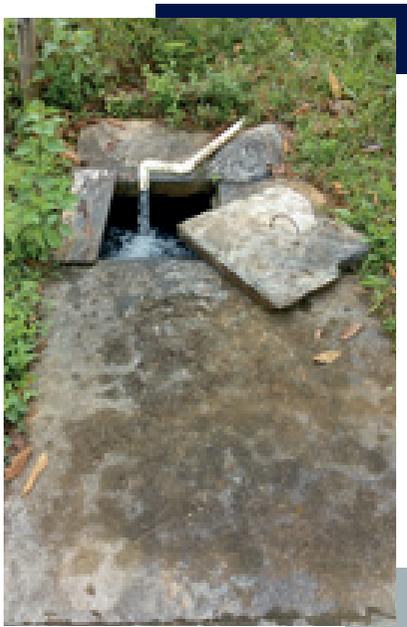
Desarenador de la vereda Santa Elena, en Corinto.
